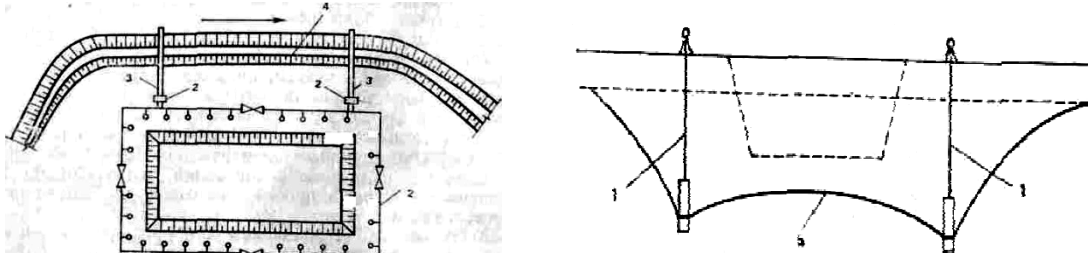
Осушение котлована иглофильтровыми установками (а – план, б – разрез): 1—иглофильтры; 2— насосная установка; 3 — сбросной трубопровод; 4—перемычка; 5—кривая депрессии.
